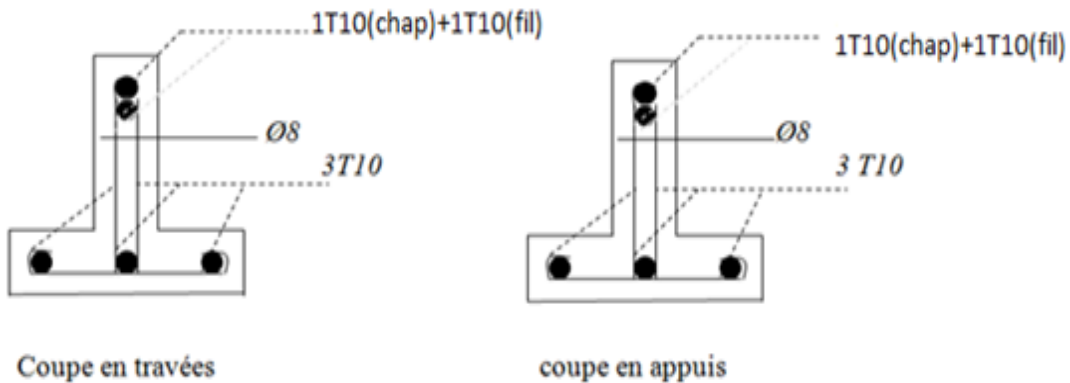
Schémas ferrailage des poutrelles Plancher Terrasse (Poutrelles intermédiaire).
